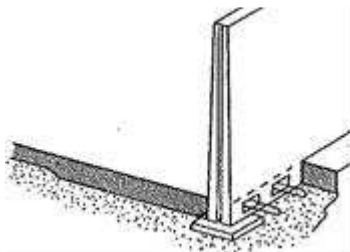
aarden wal met betonplaten (tek C.B.I. 3383)
